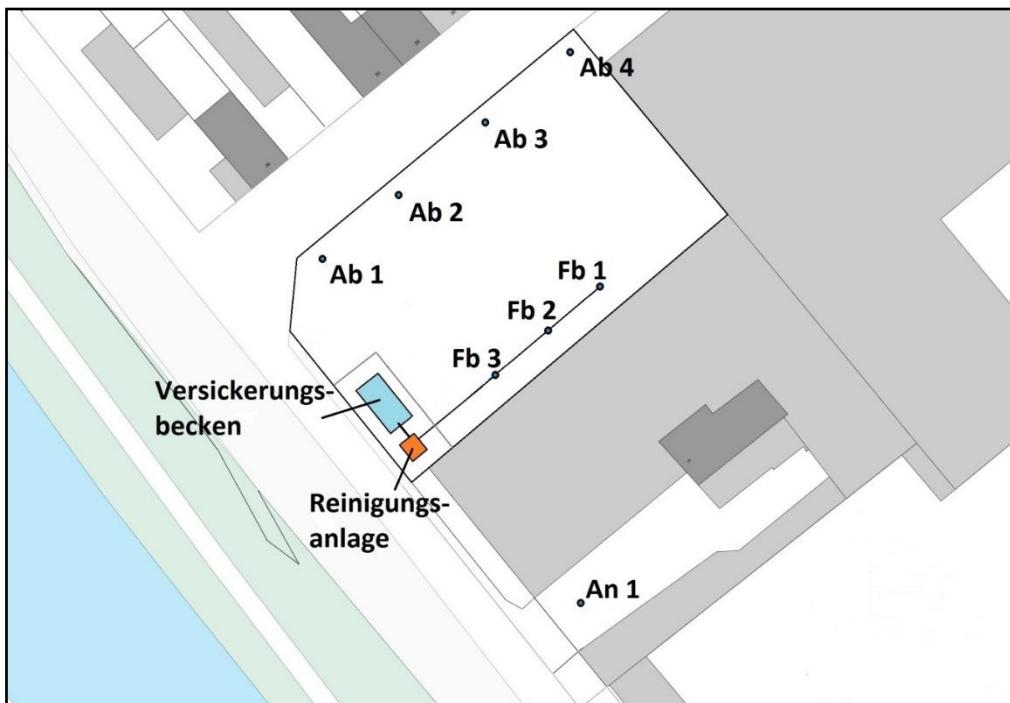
Lageplan der Grundwassersanierungsanlage
